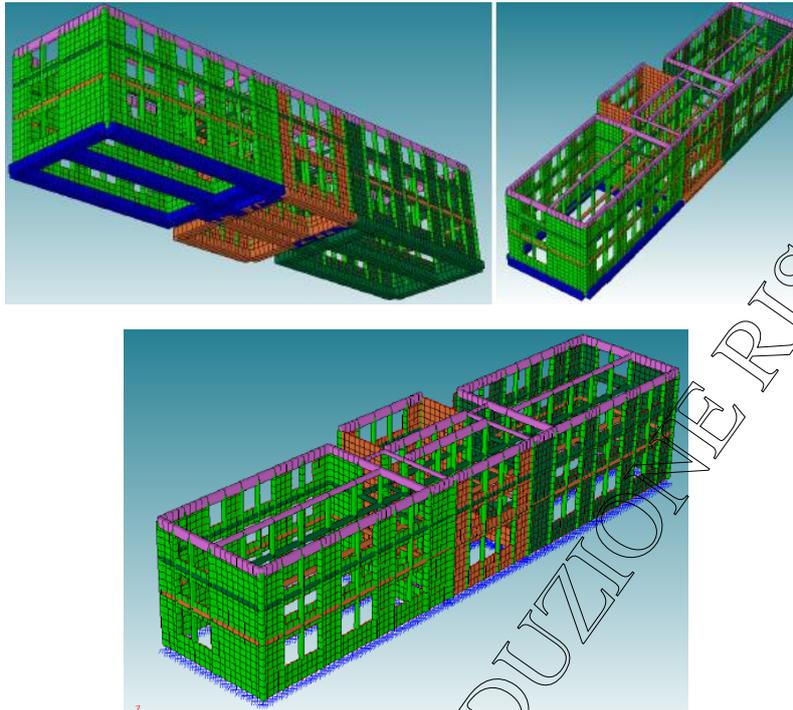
Modello di calcolo: con fondazioni (sopra) e incastri alla base (sotto)
